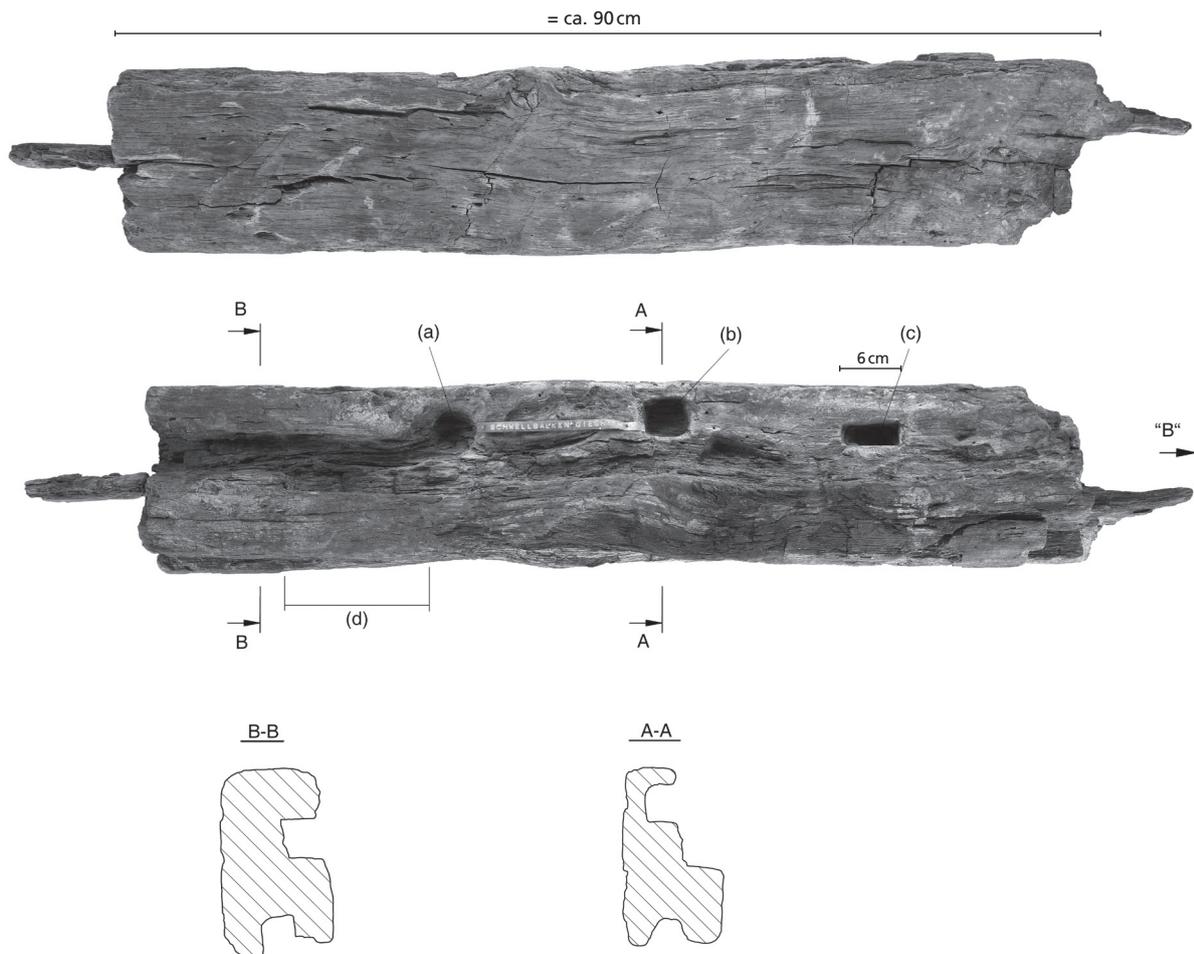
Schwellbalken einer Fachwerkkonstruktion. Bruchstück A.
